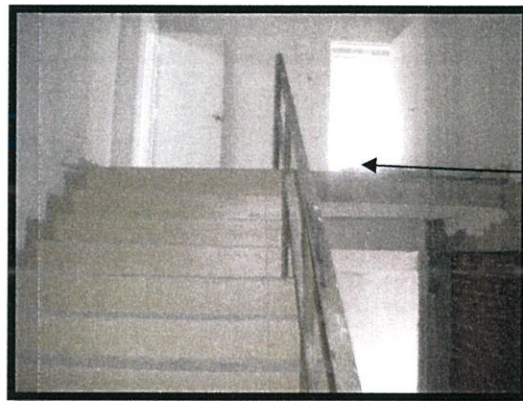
Kecacatan lapisan kalis lembap (waterproofing)
